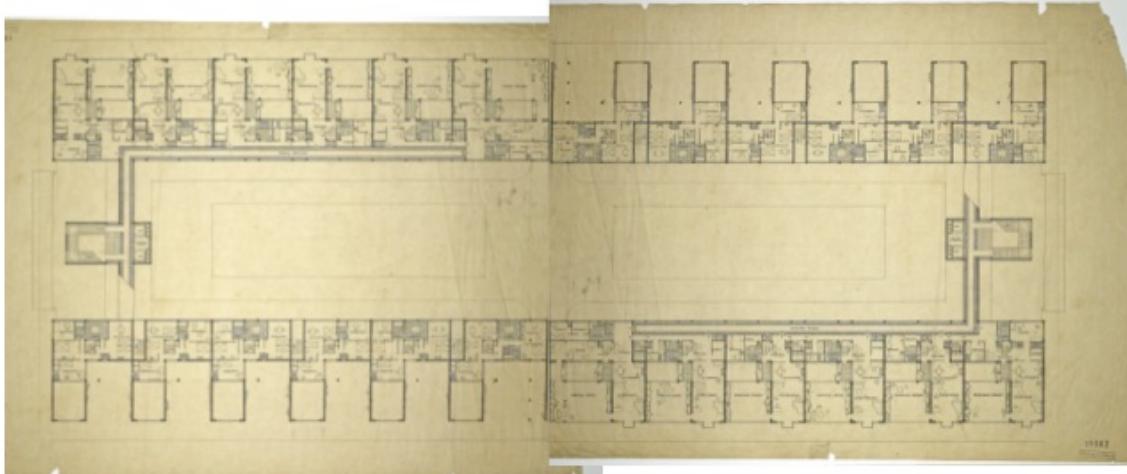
Planta de metade do projecto Immeuble-villas de 1922
